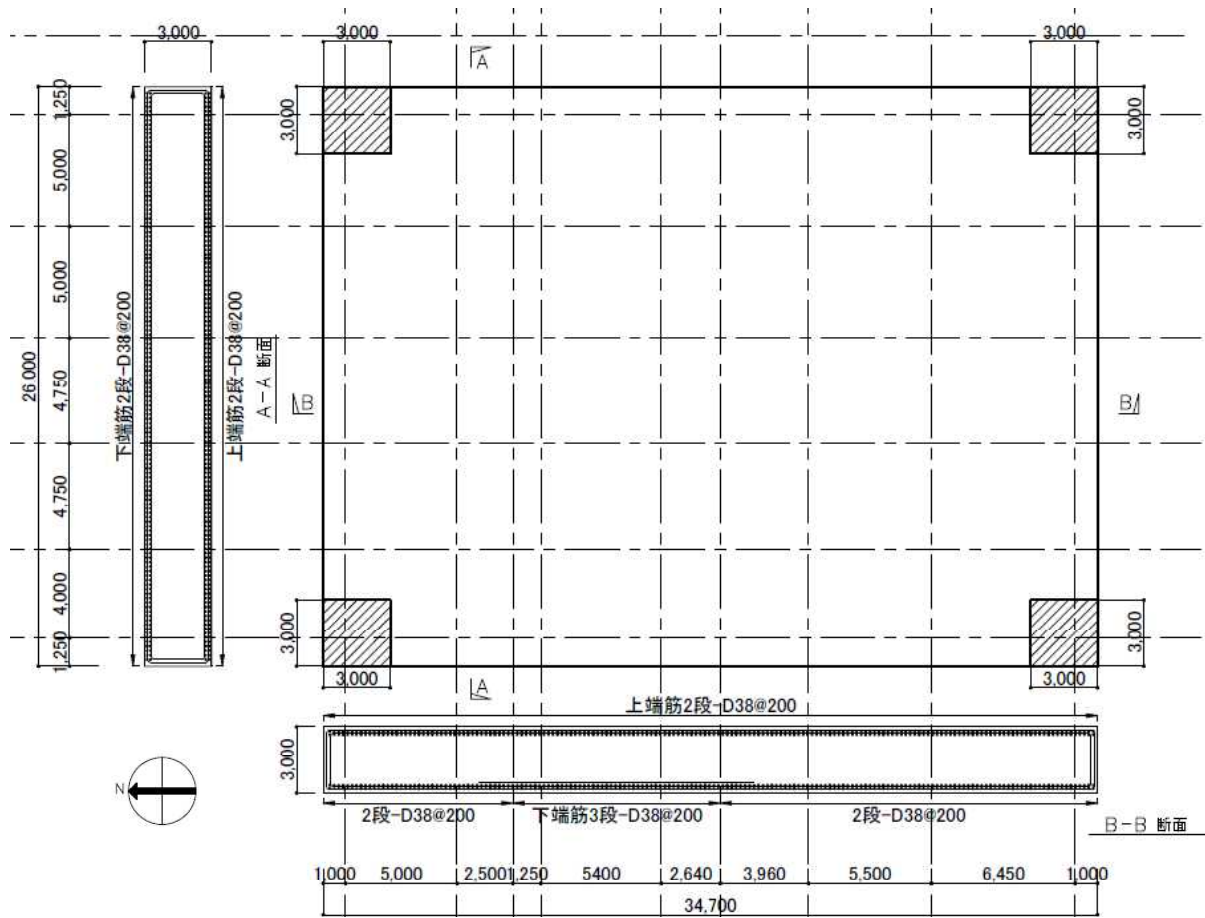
2. 4-3 基礎の配筋図 (単位 : mm)
